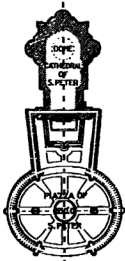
مسقط أفقي لكنيسة سان بيتر بروما
